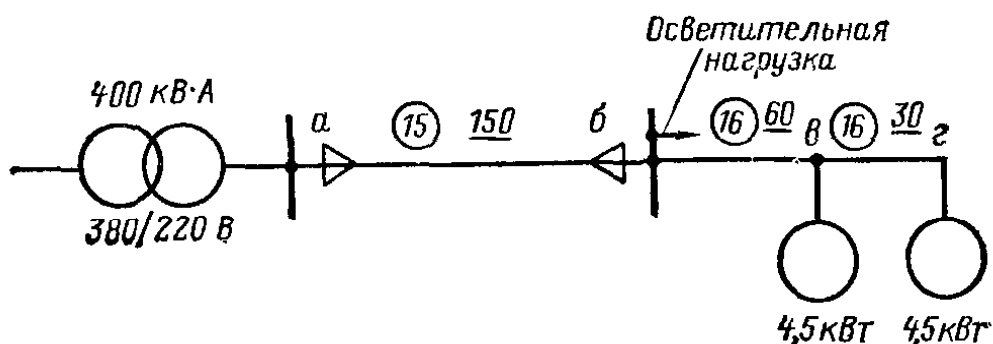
Схема к примеру 12.1. Подчеркнутые цифры указывают длины, м, цифры в кружках — сечения жил кабелей и проводов, мм²
